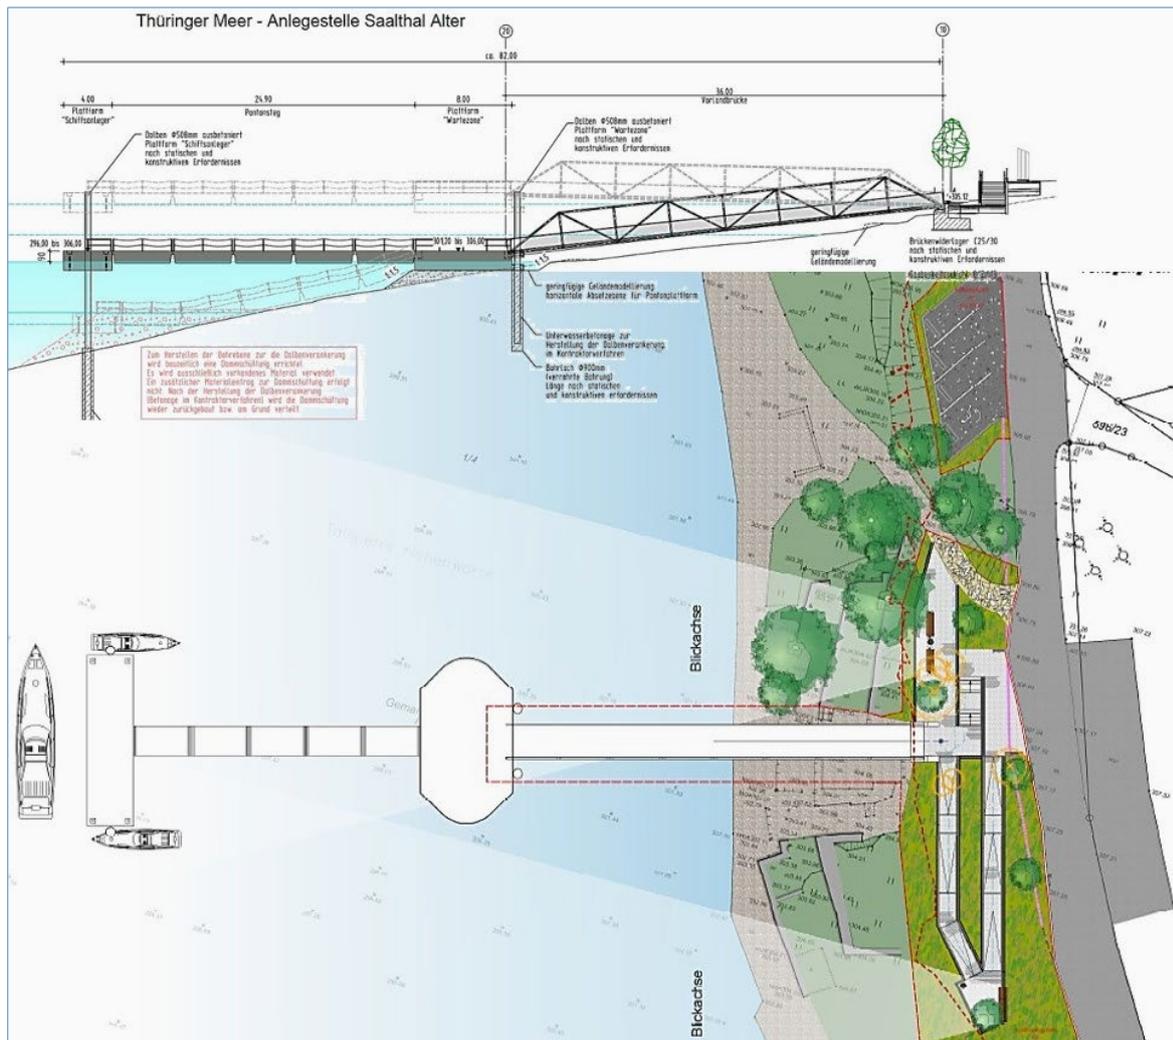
Schiffsanlegestelle –Entwurfsplanung (Übersichtsplan, Längsschnitt)
